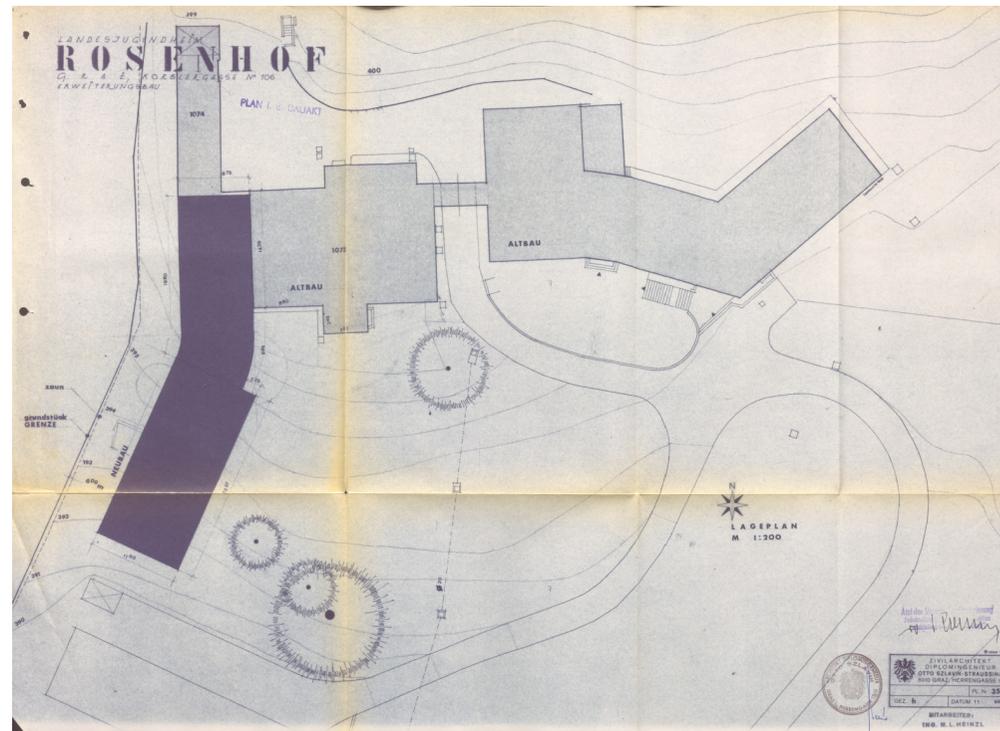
Lageplan des Lehrlingstraktes (Szlavik-Straussina, Landesjugendheim Rosenhof Erweiterungsbau 1969)
